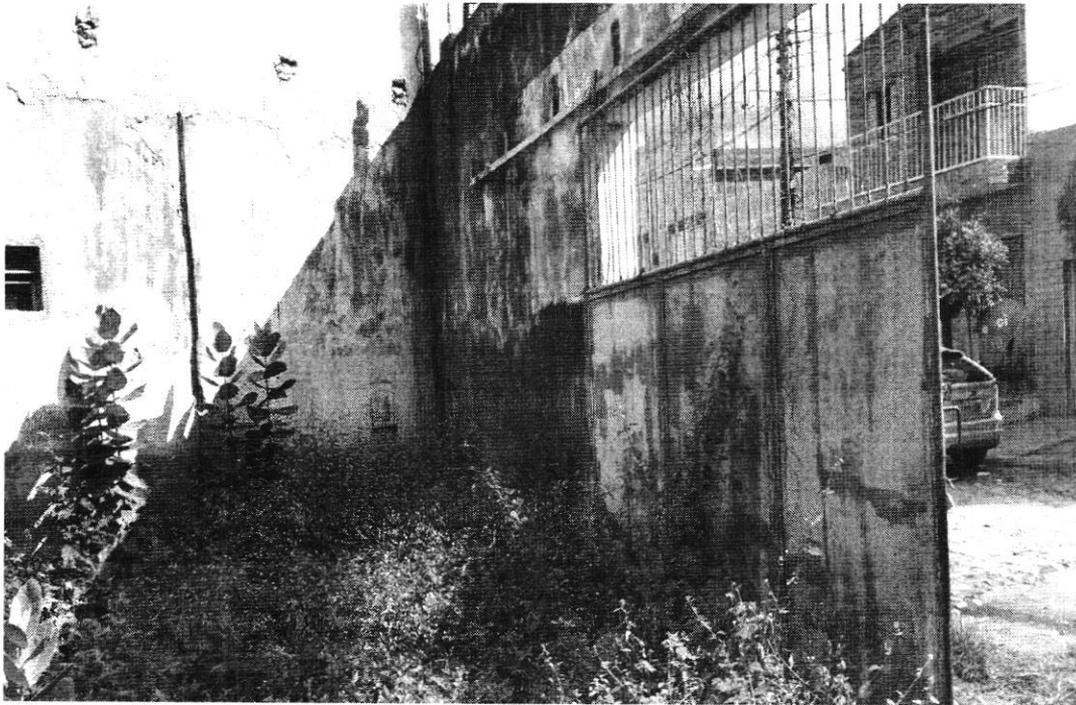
VISTA GERAL DA FACHADA PRINCIPAL
